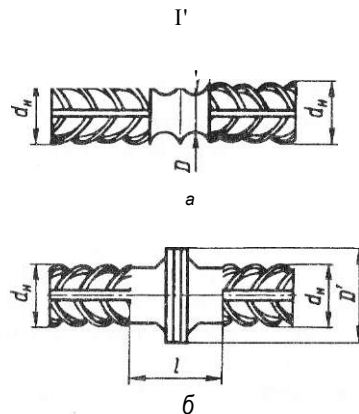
Конструктивні елементи стикових з'єднань з механічною обробкою (а) та без обробки (б) після зварювання:
